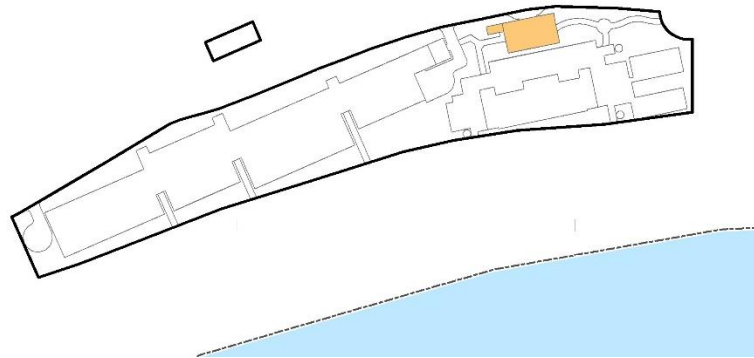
Ubicación del restaurante en la vista de conjunto del proyecto.
